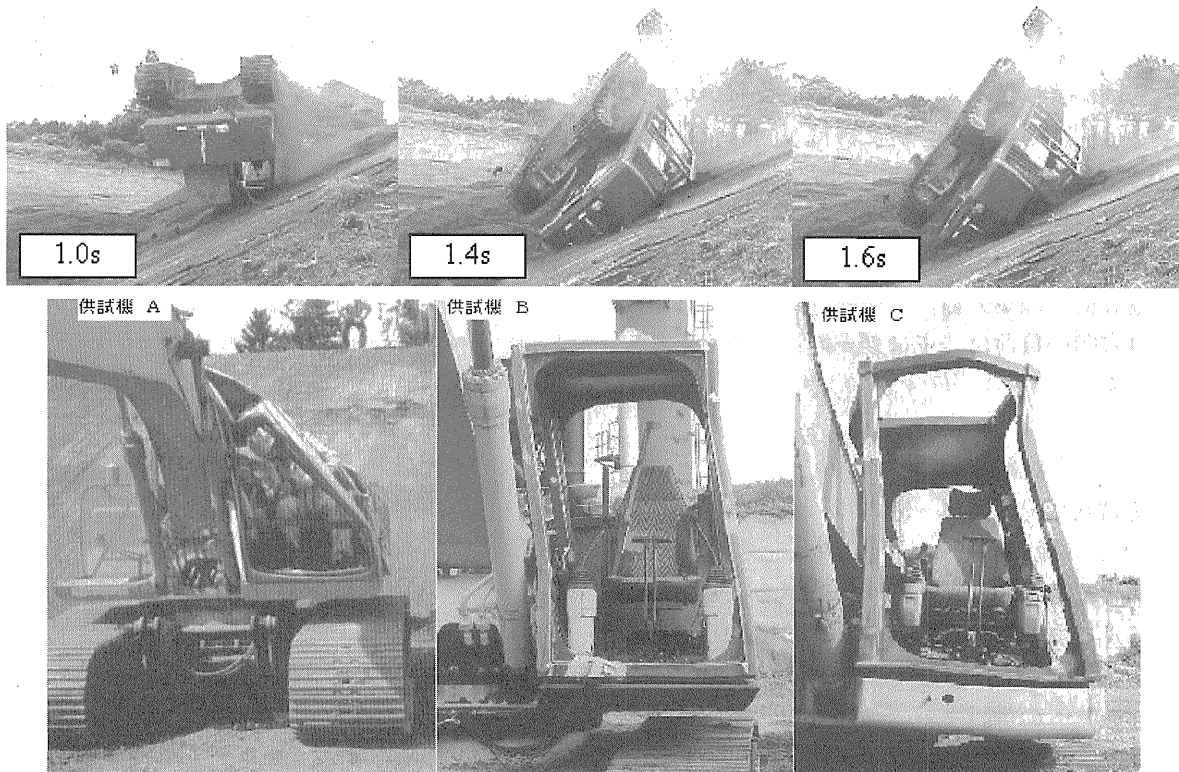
転倒実験状況(上)及び転倒後(下)の供試キャブ状況
